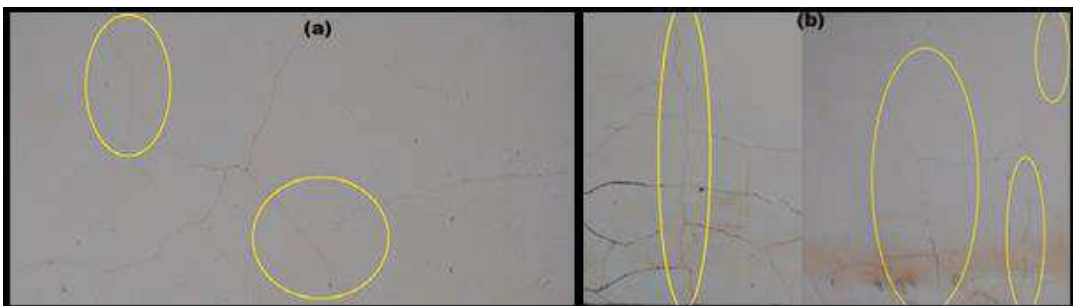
Fissuras mapeadas presentes nas edificações.
